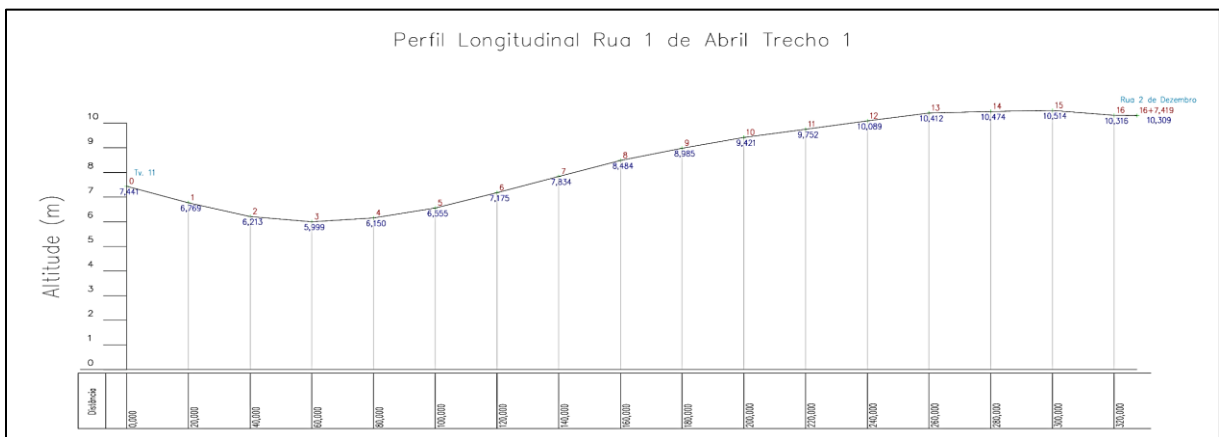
Perfil longitudinal Rua 1º de Abril (trecho 1)
